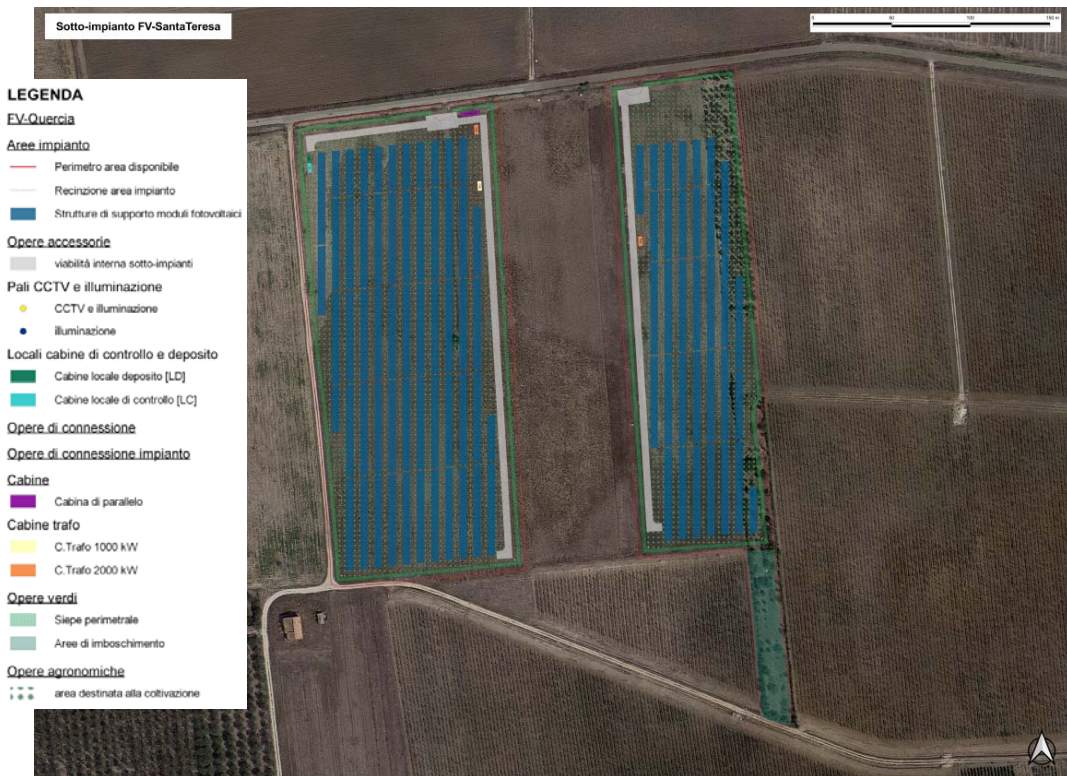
Layout agro-fotovoltaico sotto-impianto FV-Santa Teresa
